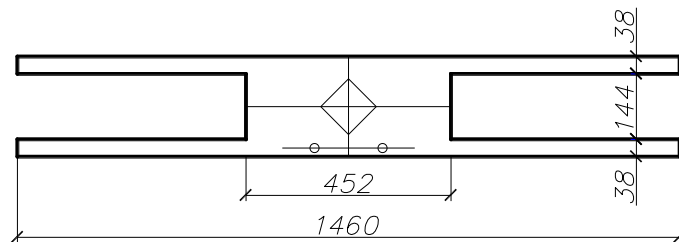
«Поперечные сечения многопустотной плиты к расчёту по образованию трещин» [25]
